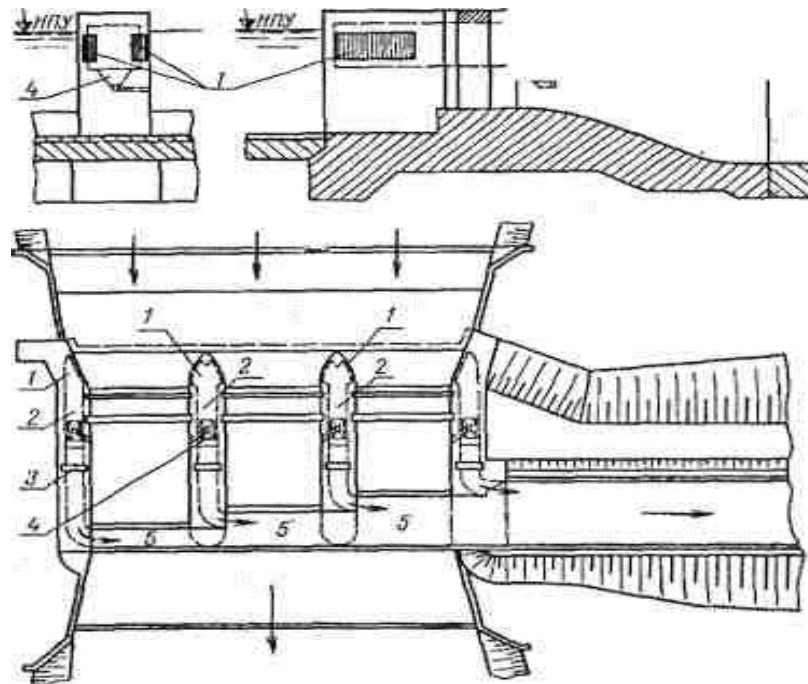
Бычковый водозабор с вертикальной решеткой:
